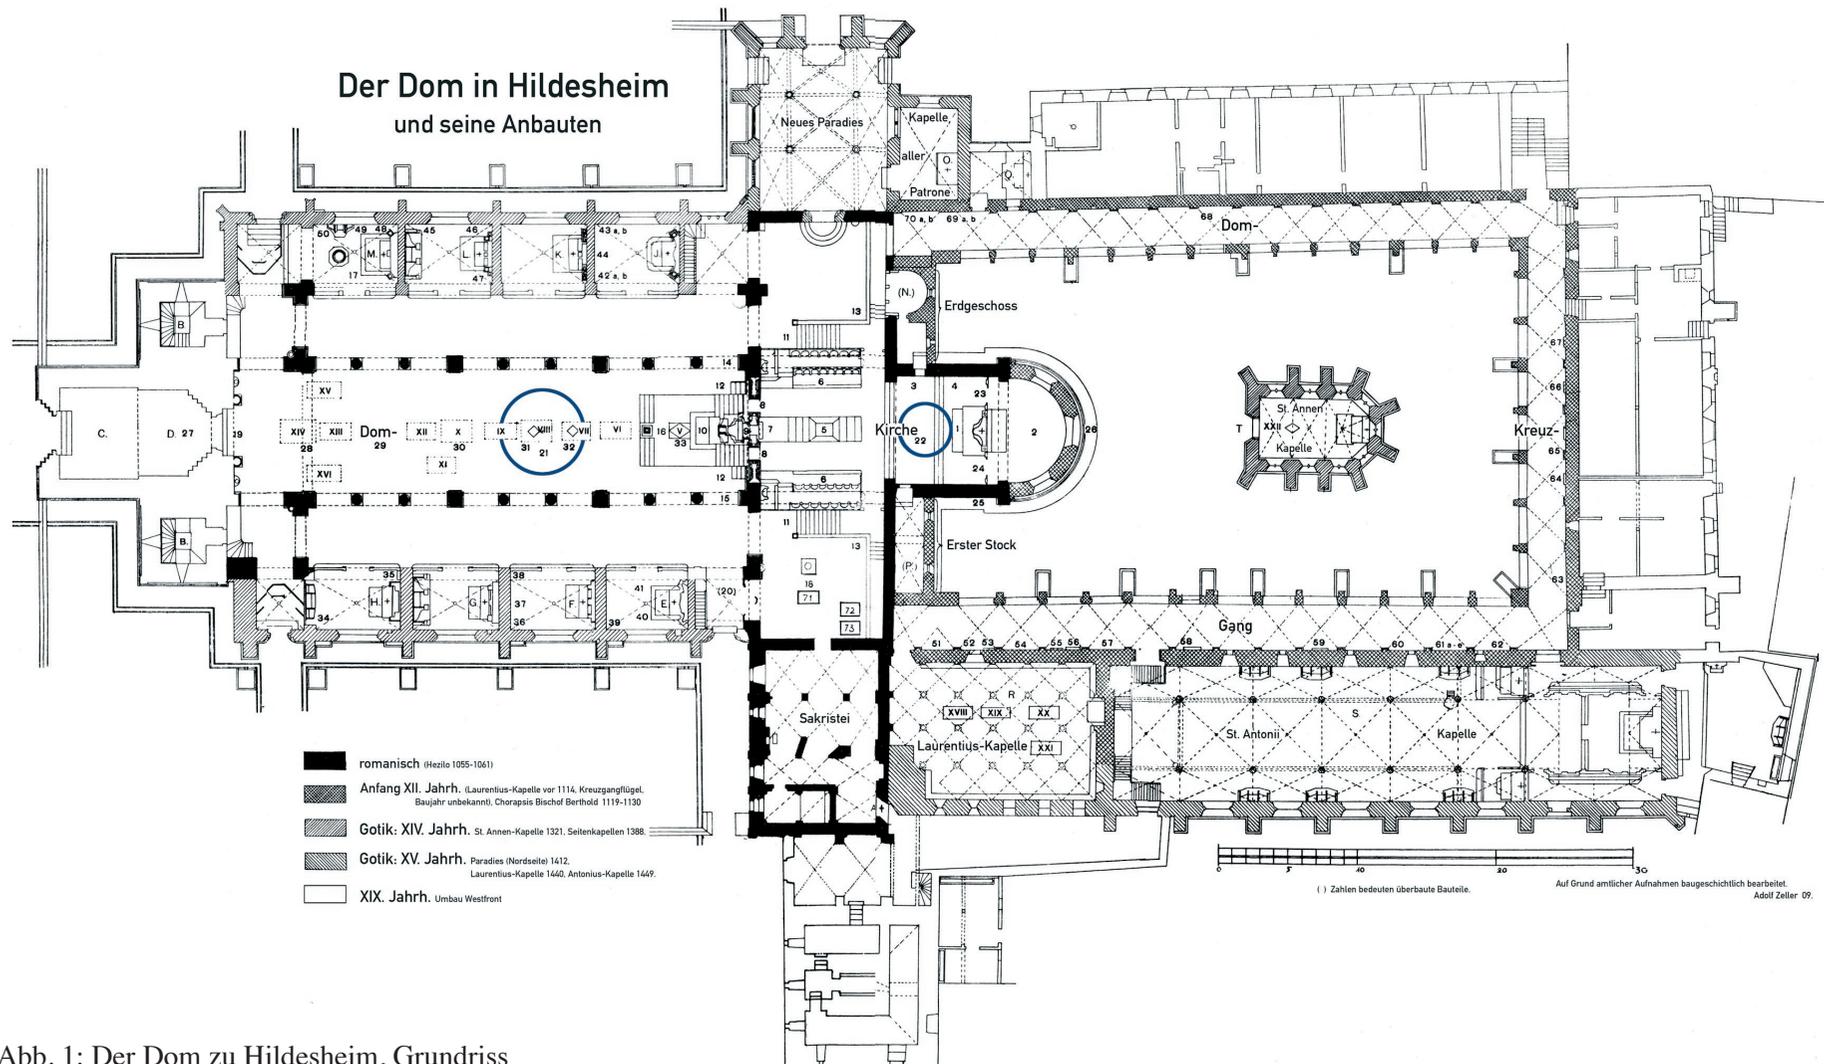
Der Dom zu Hildesheim, Grundriss
